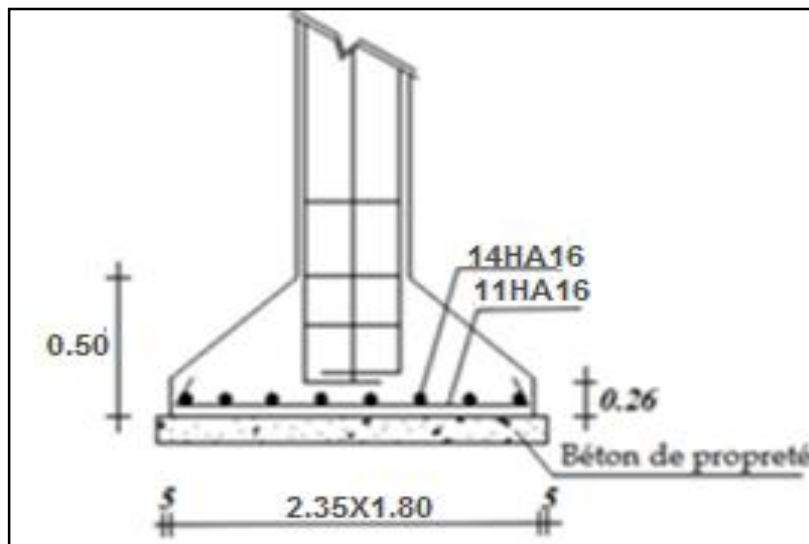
Exemple de ferrailage d'une semelle isolée sous poteau de rive.
